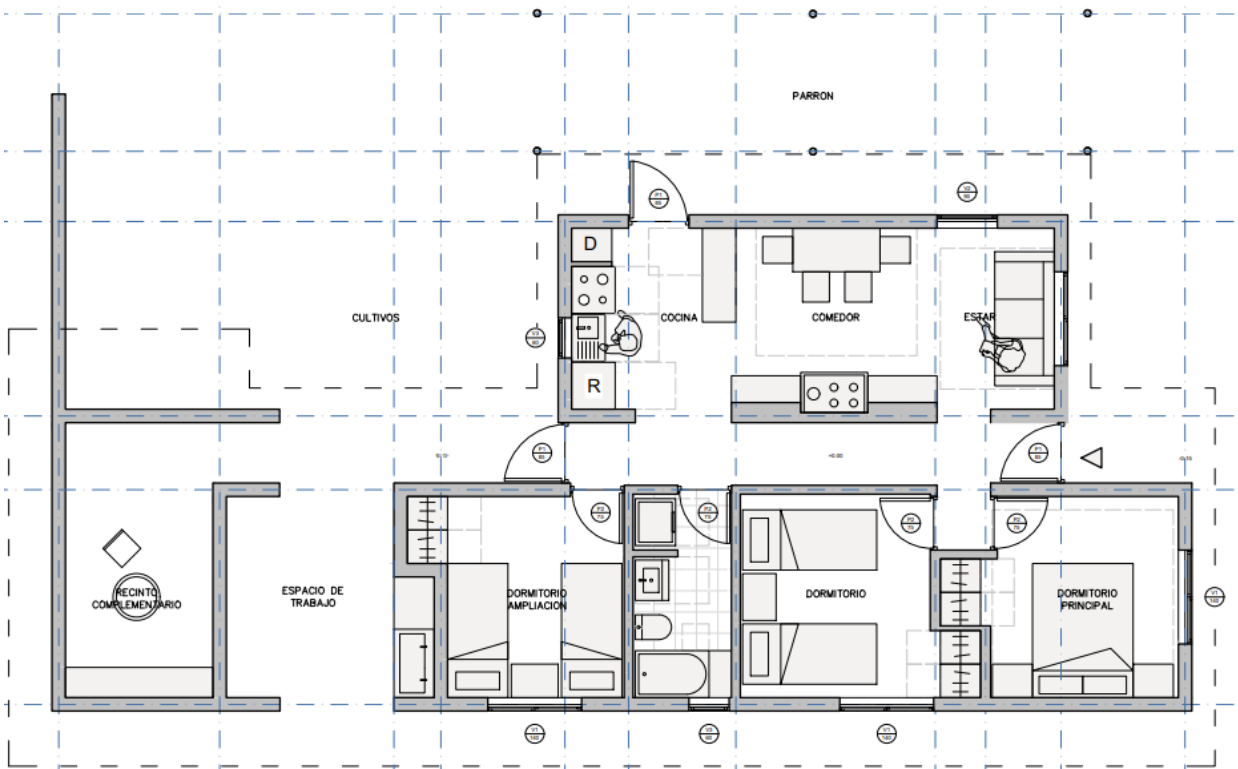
Planta arquitectónica Casa Lumbre adaptada a los requerimientos normativos del DS10, ajustado en conjunto con la practicante designada
